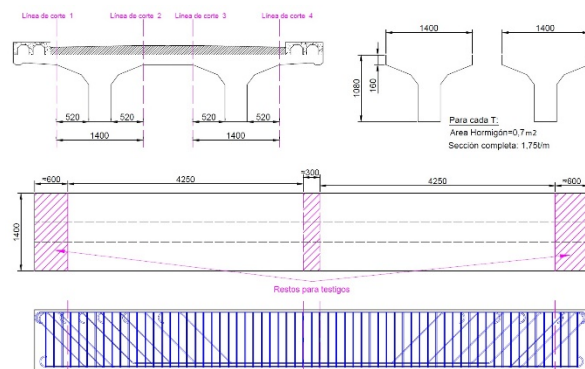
Cortes en la viga para obtener las piezas a ensayar a cortante.
